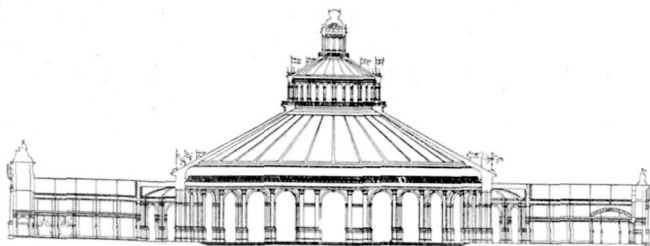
Ausstellungsanlage Wien 1873. Schnitt
